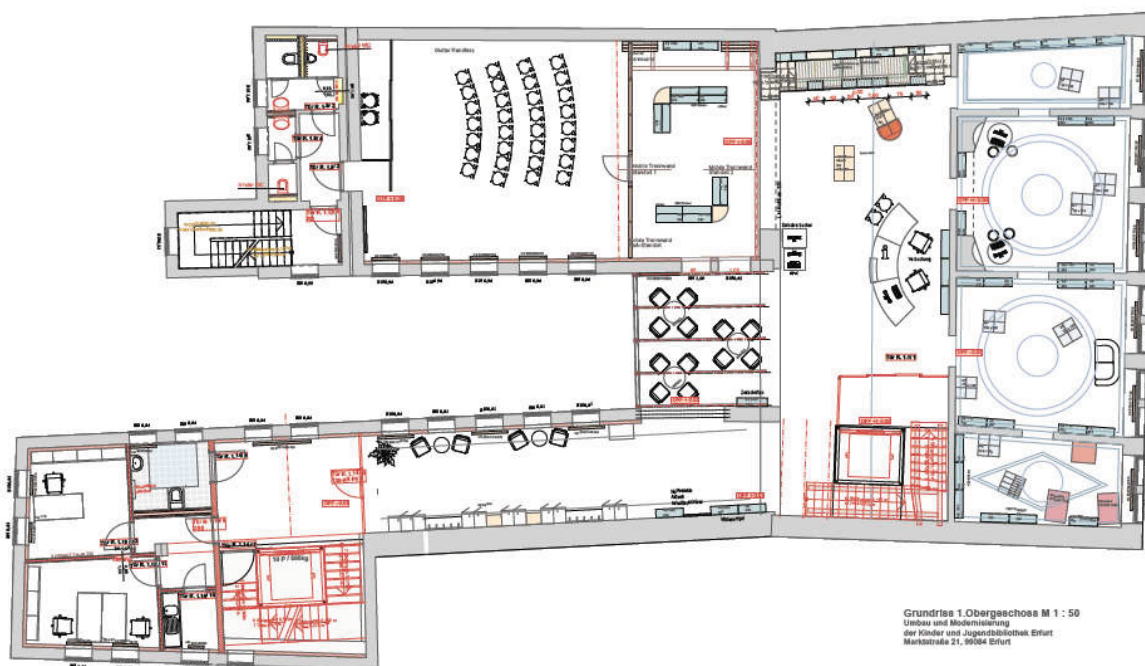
Grundriss 1. OG. © S. Hauschild.
